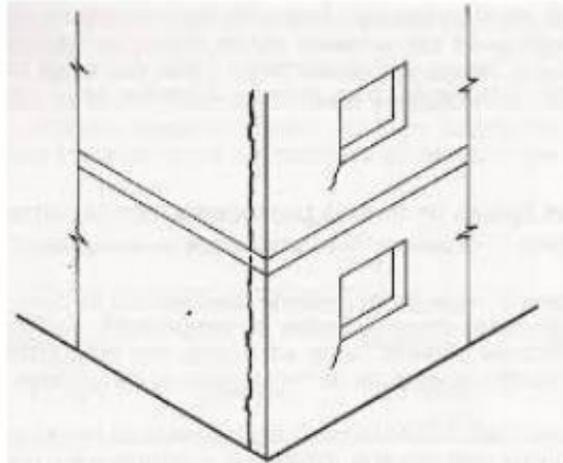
Fissuras verticais por sobrecarga vertical uniforme
